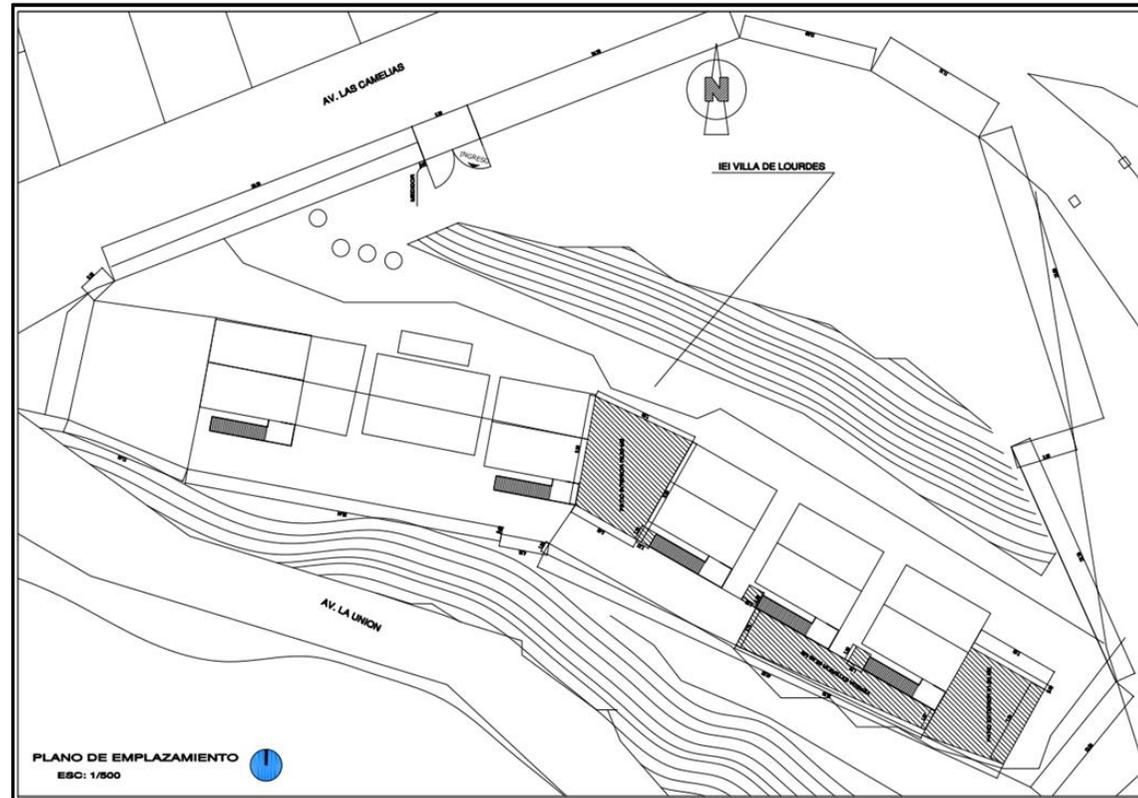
Plano de intervención de cerco perimétrico: 250.76 m., murete para medidor de luz, losas de piso y nueva puerta de ingreso.
